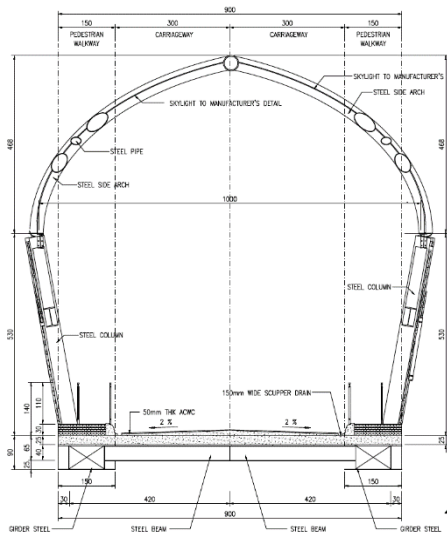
Denah jembatan Sungai Ciliwung penghubung 2 gedung
